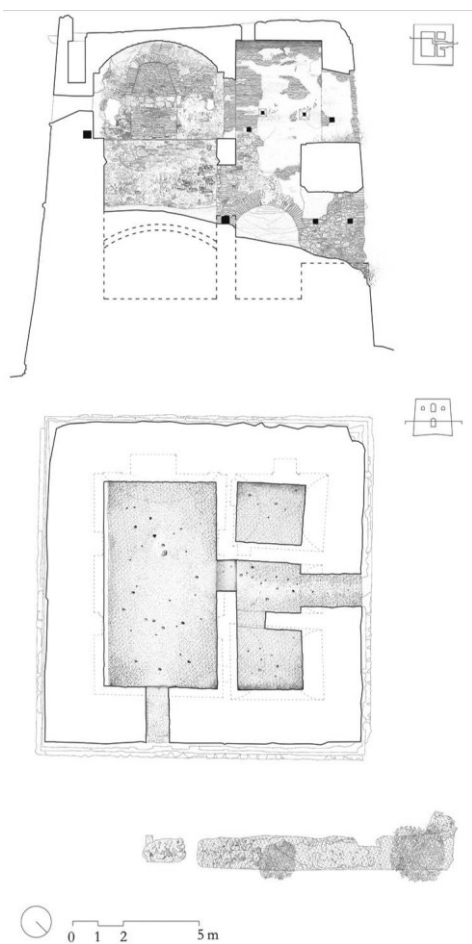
Sezione e pianta dello stato di fatto, 2017
